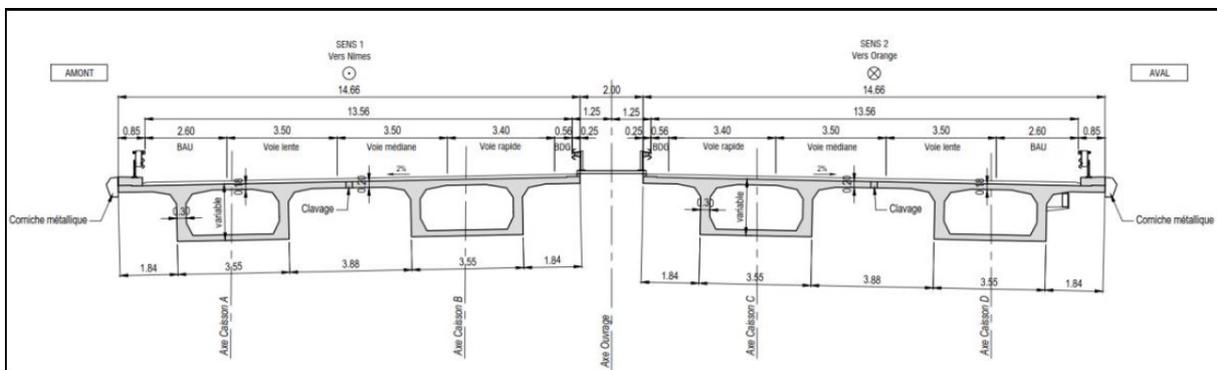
Coupe transversale fonctionnelle de l'ouvrage (Arcadis, 2022)
